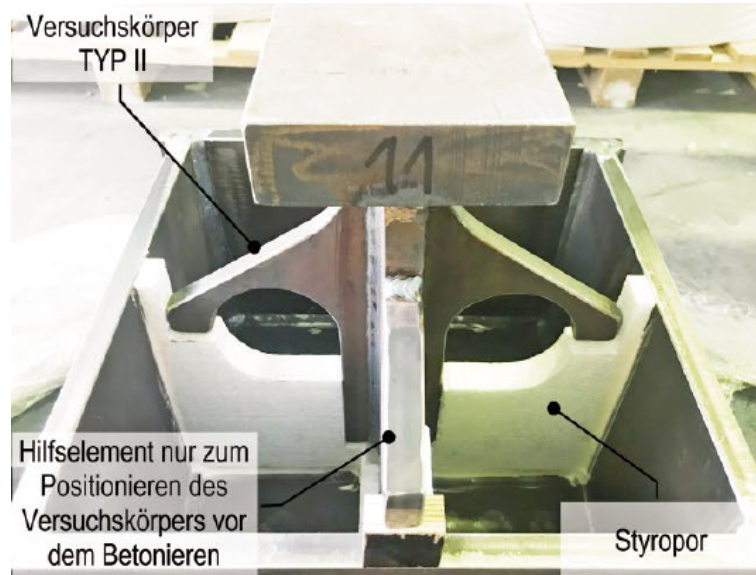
Versuchskörper vor dem Betonieren [30]
